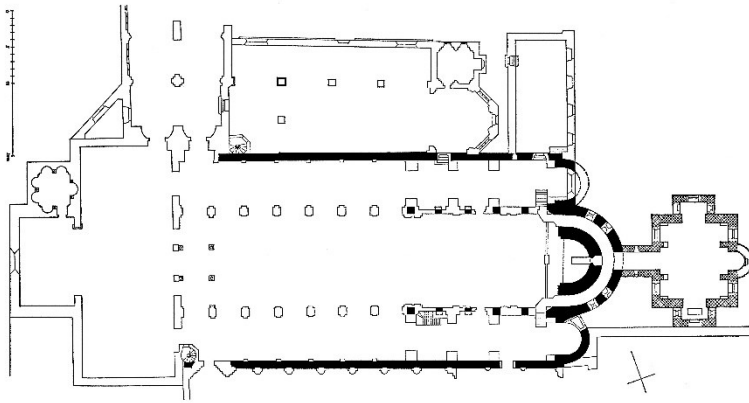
Grundriss von St. Emmeram in Regensburg
